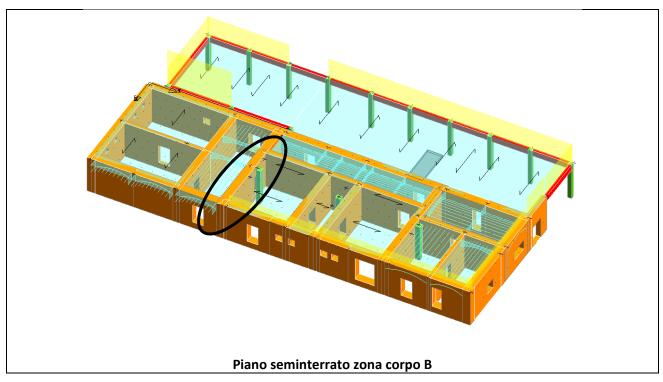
Zona di interazione strutturale tra i corpi di fabbrica A e B
